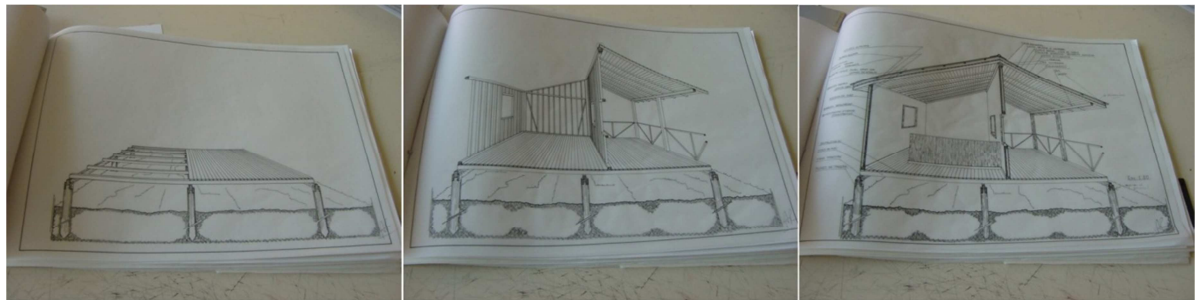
Propuesta para Iguazú. Láminas de secuencia constructiva en corte fugado.
